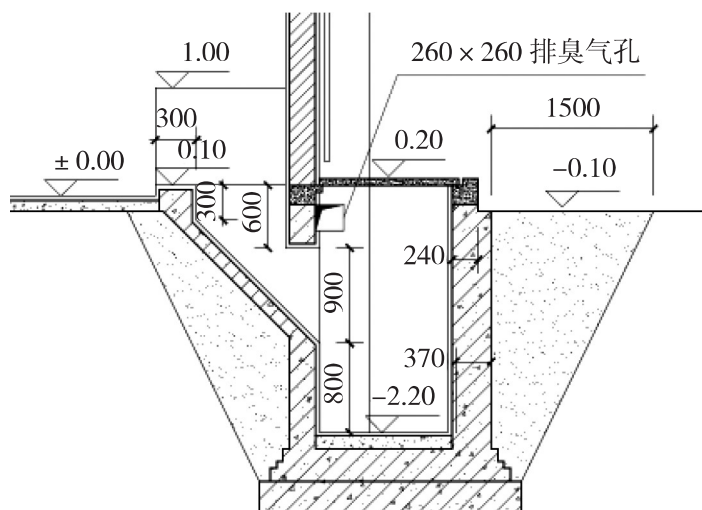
二类旱厕的贮粪池局部剖面示意图 (mm)
